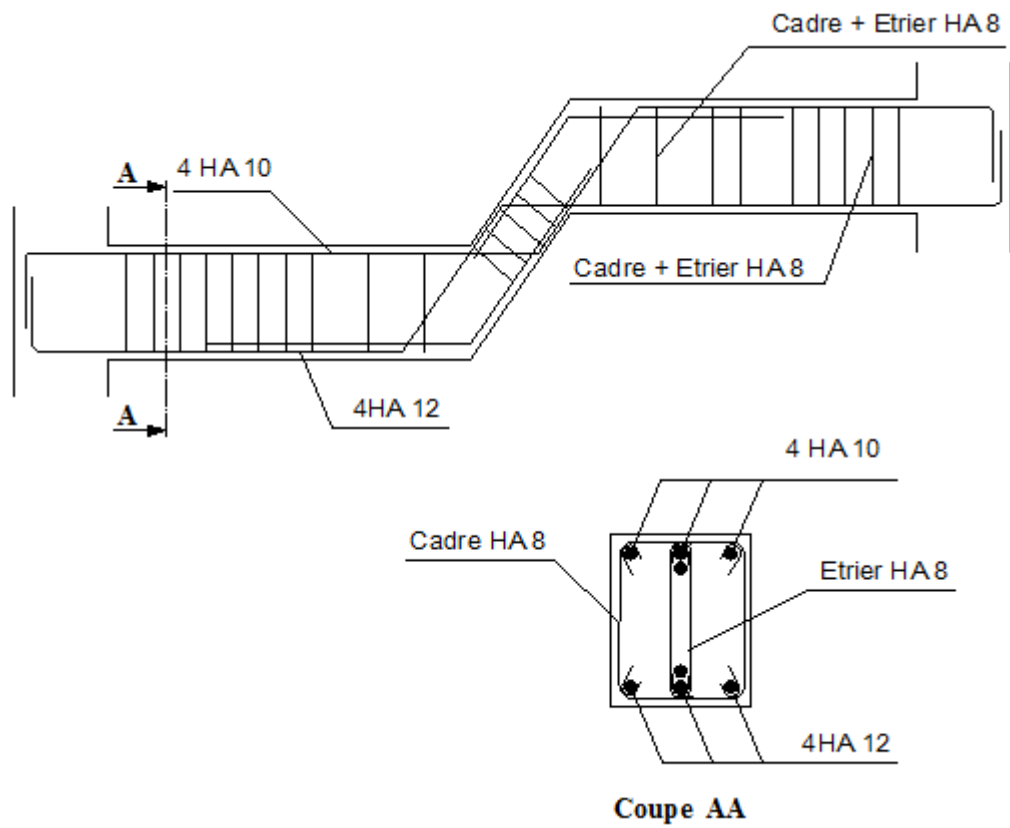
Ferrailage de la poutre palière brisée.
